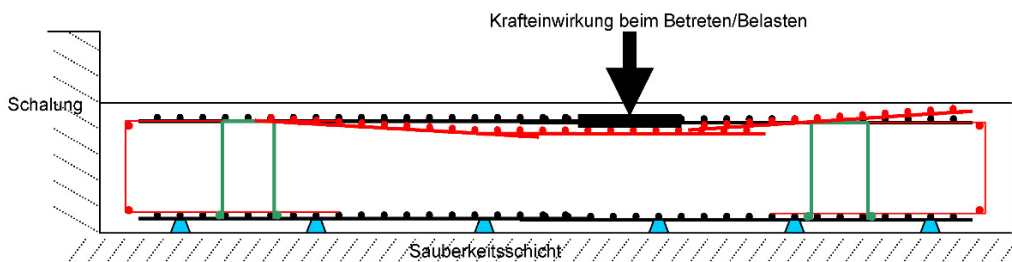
Prinzip des „Einknickens und Aufspreizens“ der nicht unterstützten Flächenbewehrung (rot) bei einer Belastung
